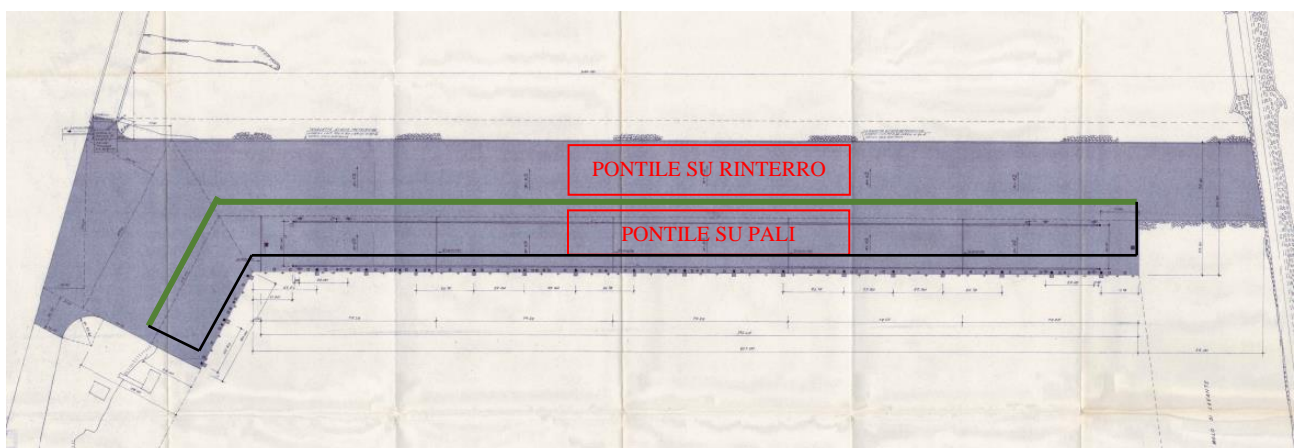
Pianta generale banchina – Giunto di dilatazione longitudinale
